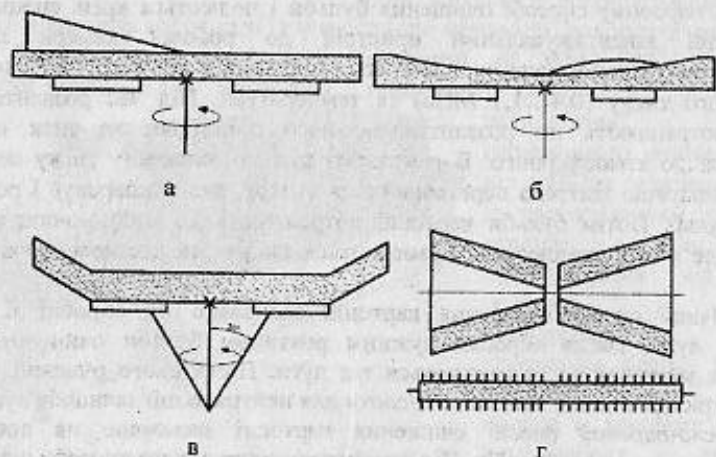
Форми робочих органів очищувального устаткування: а – дисківі; б – дисківі з закругленими кінцівками; в – конусні; г – роликіві
